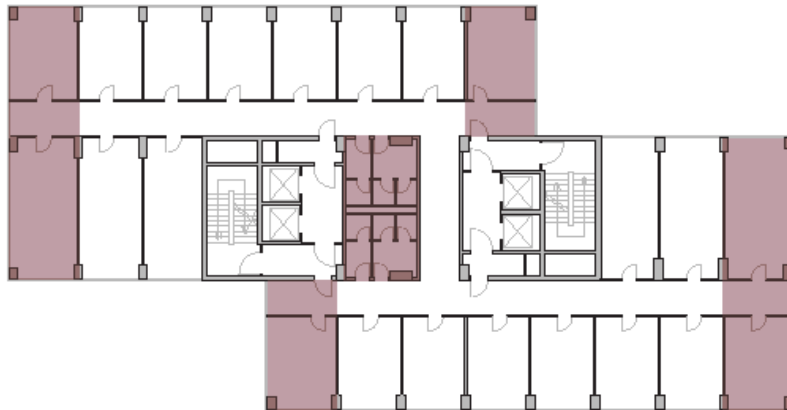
Progetto strutturale esecutivo. Pianta piano tipo (Integrazione del 03/02/88)
